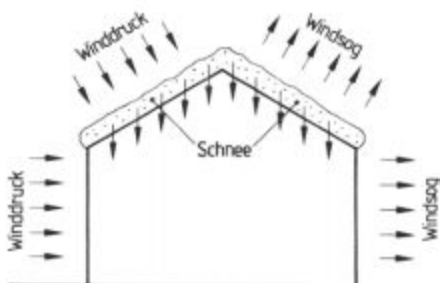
Das Gebäude wird durch Winddruck und -sog belastet, das Dach zusätzlich durch Schnee
